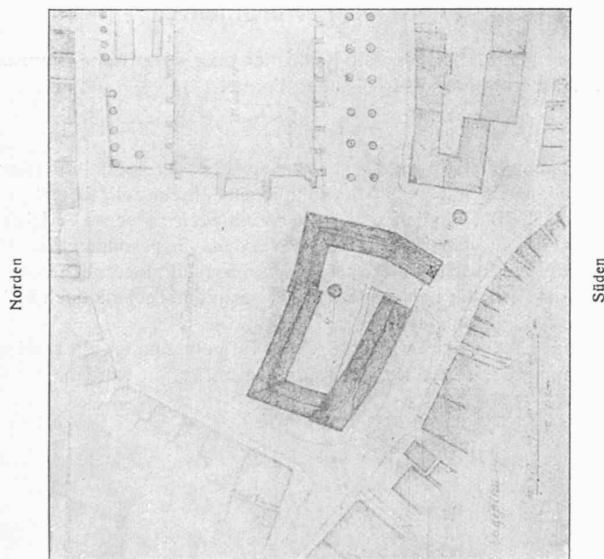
Entwurf „Barfüsser Hof“. — Lageplan 1 : 2600.
